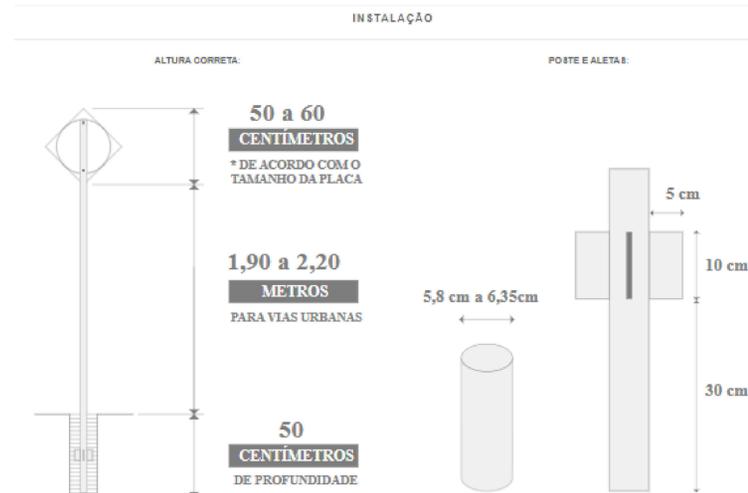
Detalhe do Dispositivo Anti-Giro e da Fundação
